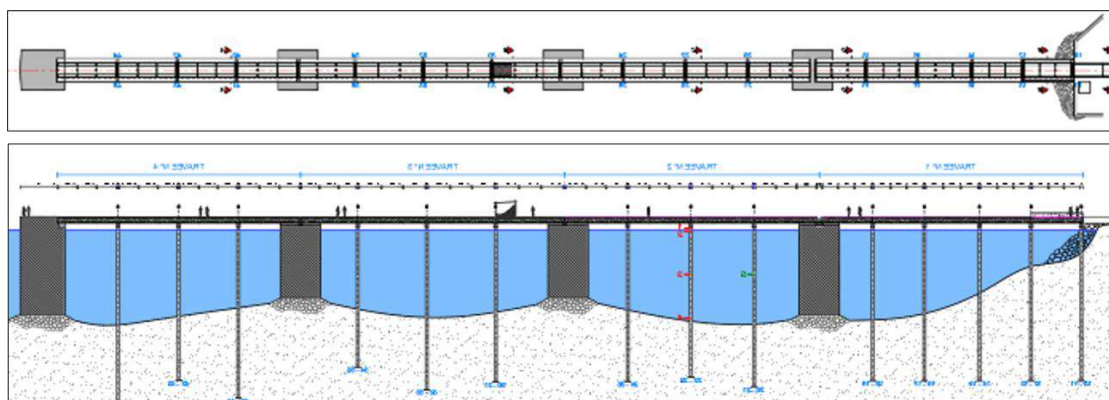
Plan et coupe longitudinale de l'ouvrage existant (source MOA)
